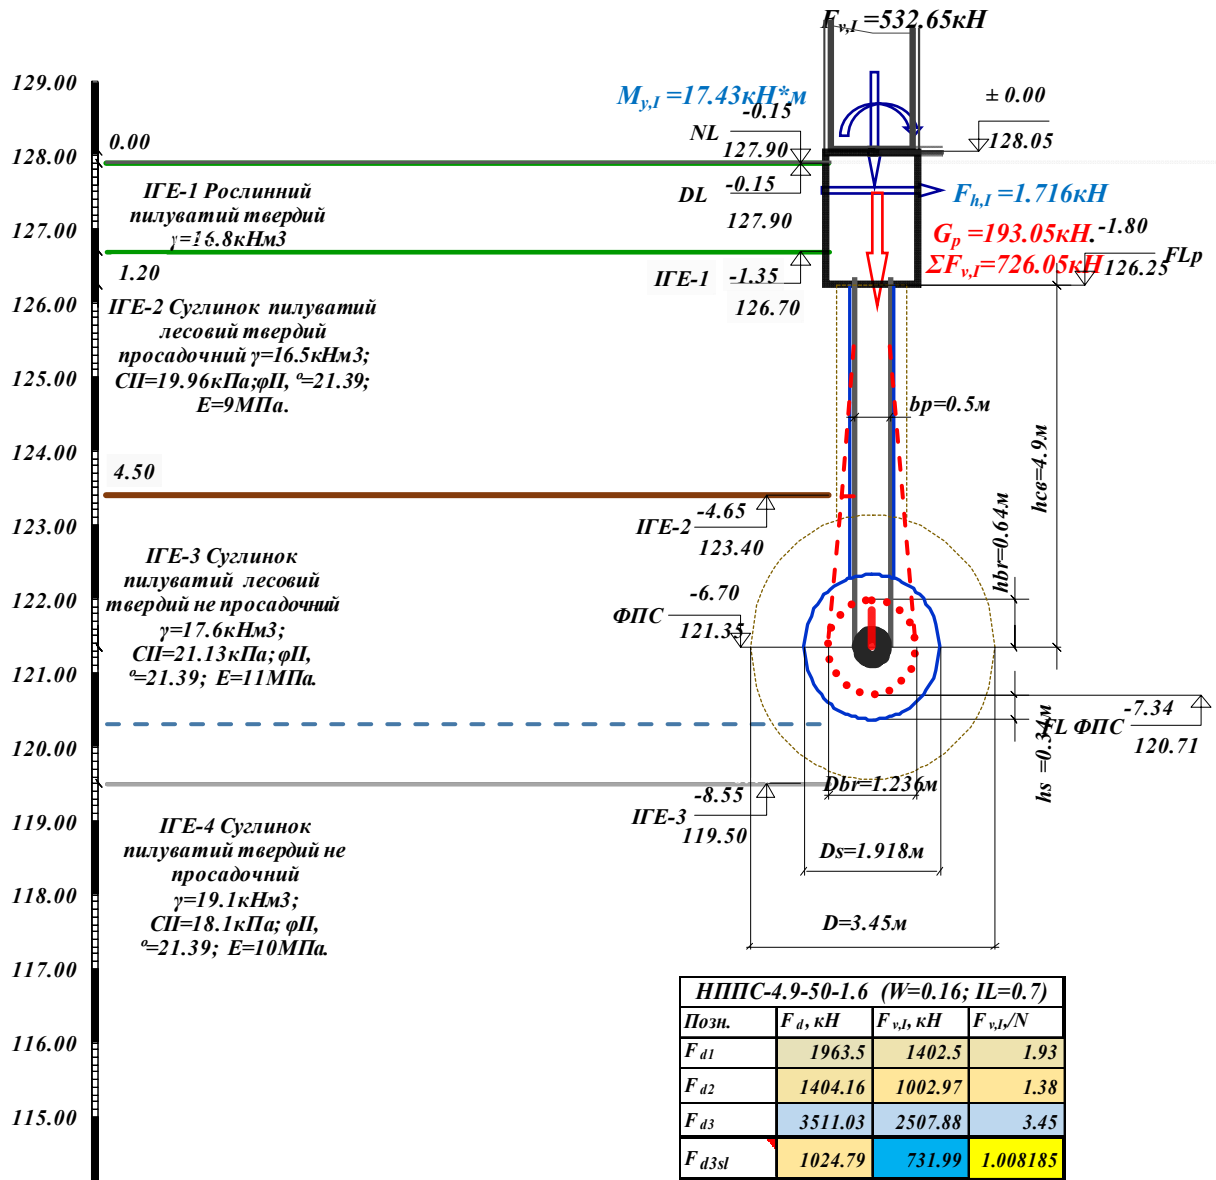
Фундамент з НППС-4.9-50-1.6 під колони вздовж осей А і Г.
